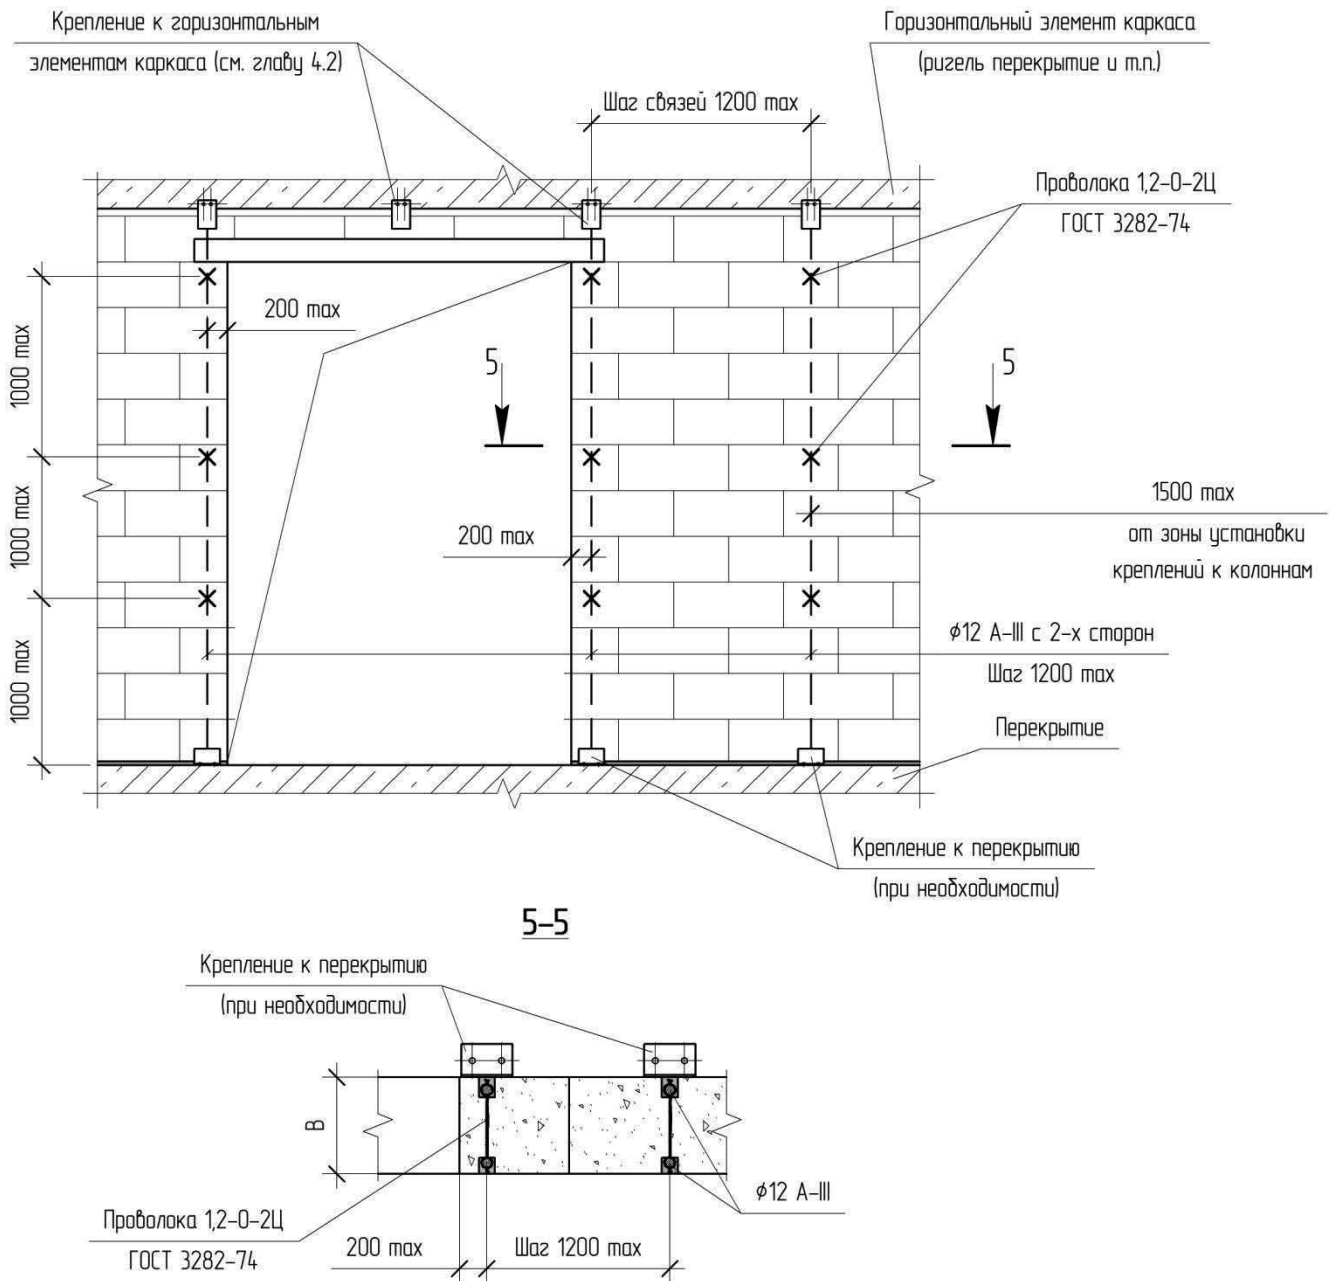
Схема вертикального армирования стен отдельными арматурными стержнями
